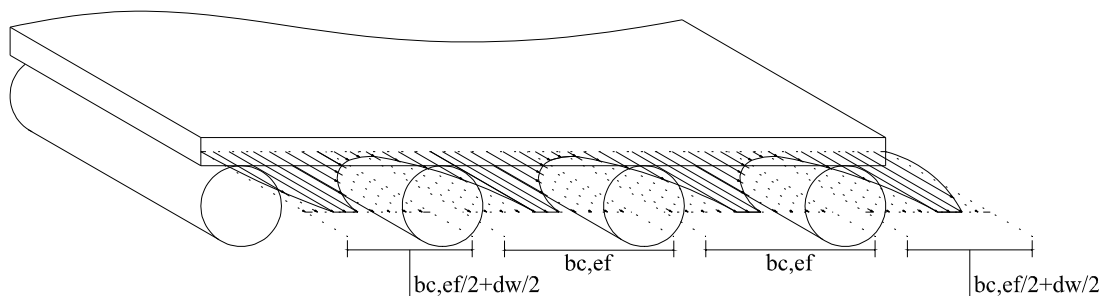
Distribuição da tensão normal sobre a laje de concreto
